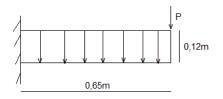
SCHEMA DE FERRAILLAGE DE L'ACROTERE
